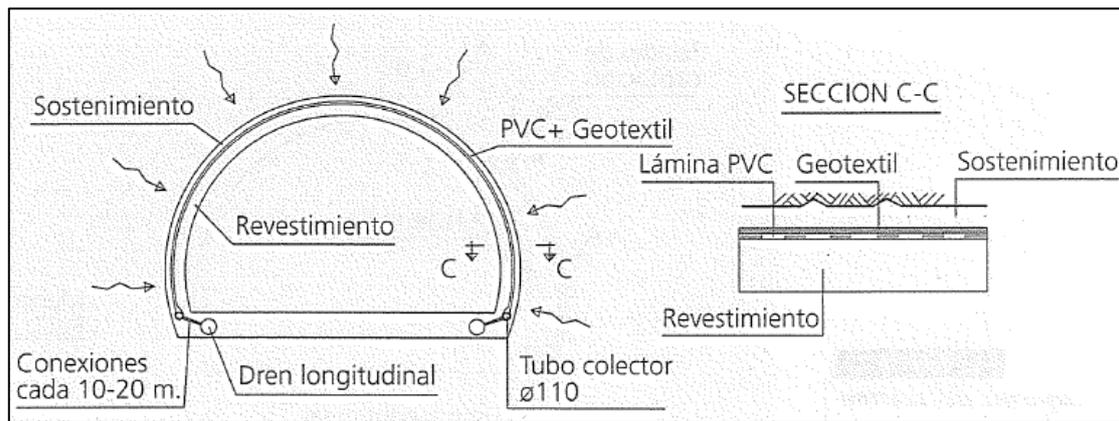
Esquema de las bandas drenantes. Todo Manual de Túneles (Carlos Lopez Jimeno y otros).
